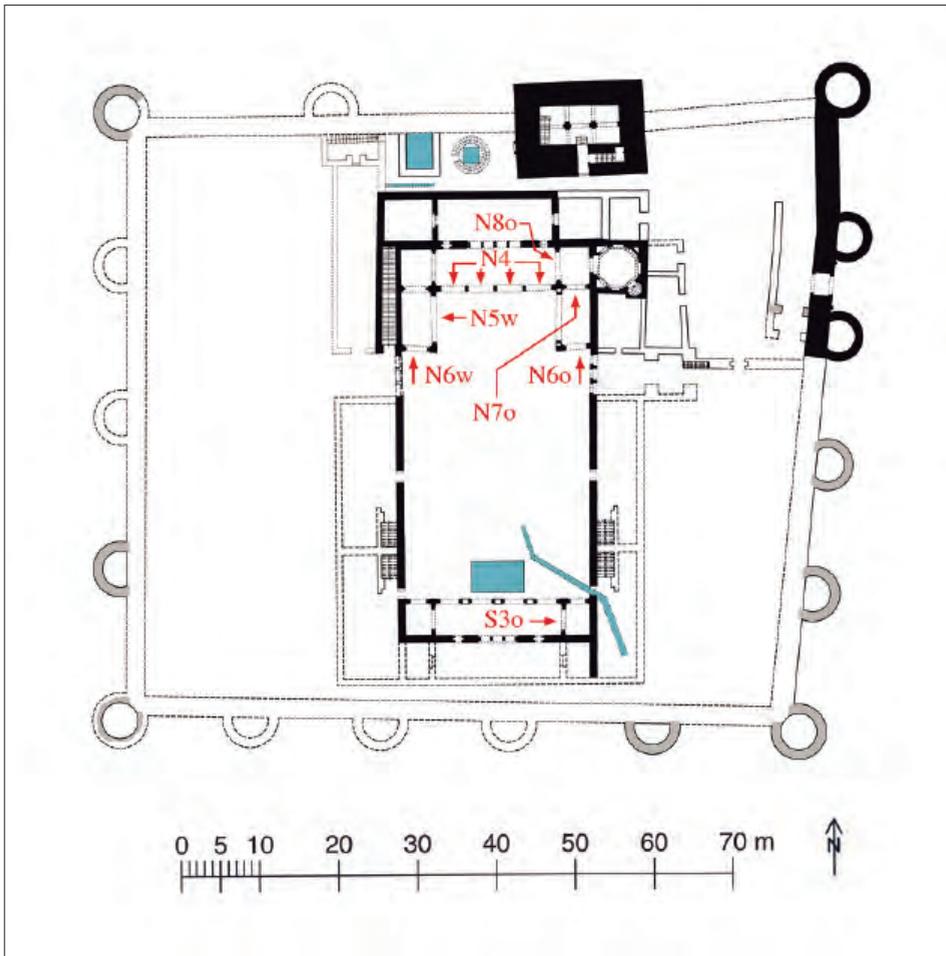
Plano de planta del Palacio Aljafería con la indicación de los intradoses comentados.
